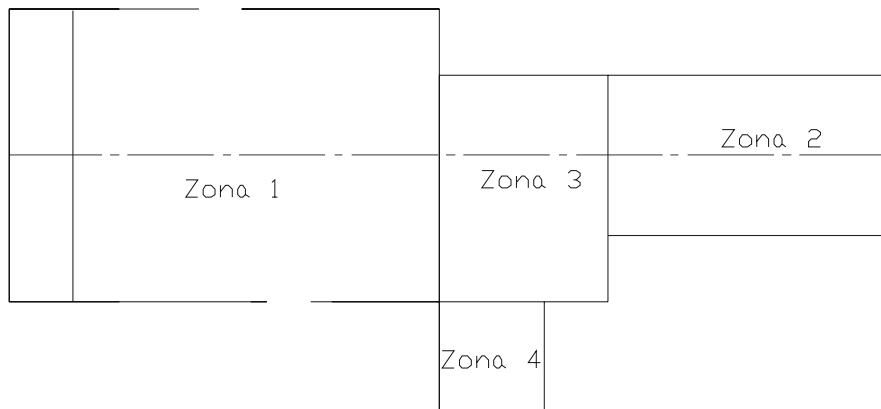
Croquis de Planta Belén segmentada por zonas
